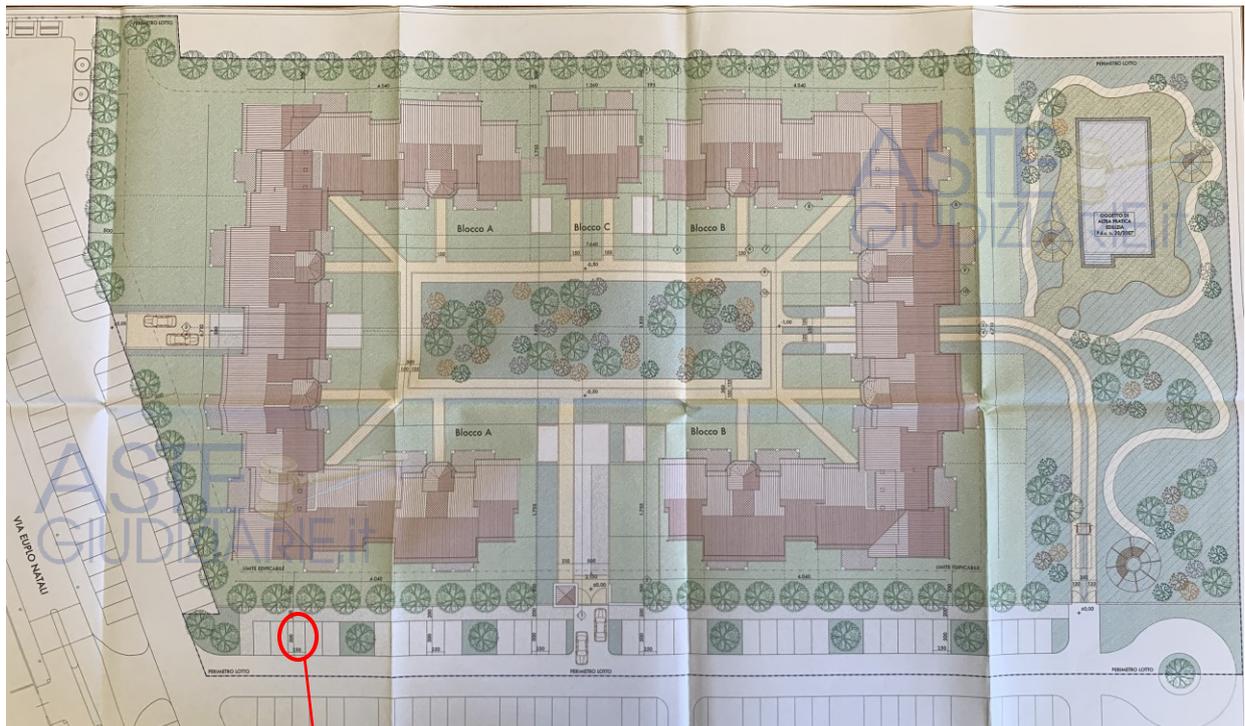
Estratto planimetria generale D.I.A. Prot. 36738 del 18.12.2007
